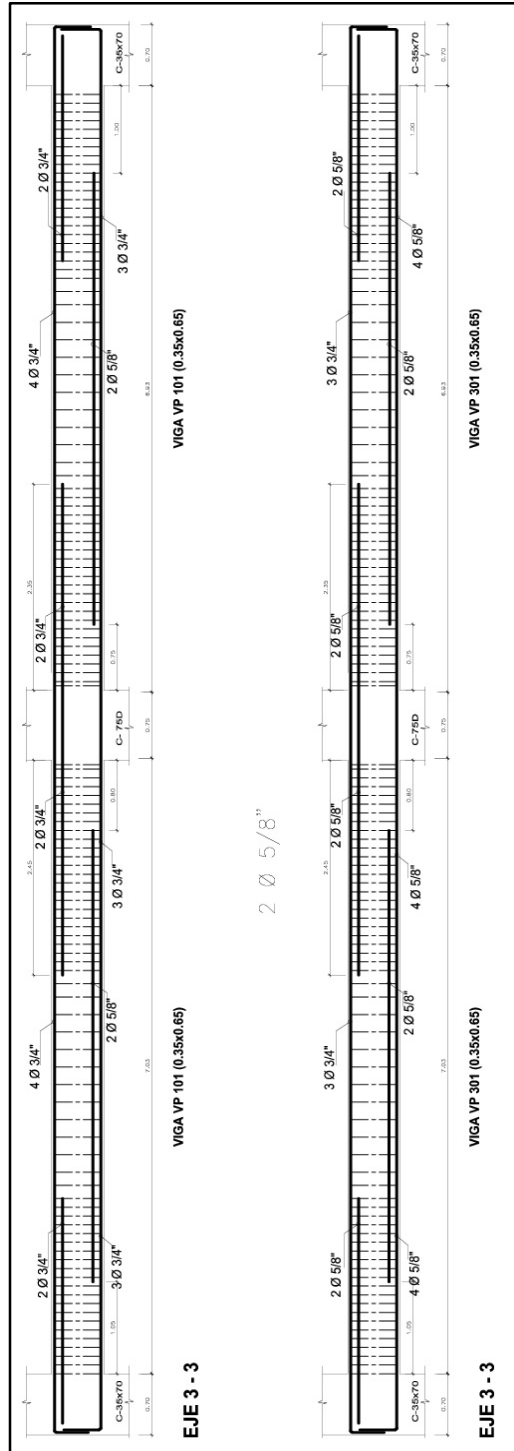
Acero longitudinal en vigas del eje 3-3 del primer y tercer nivel.
